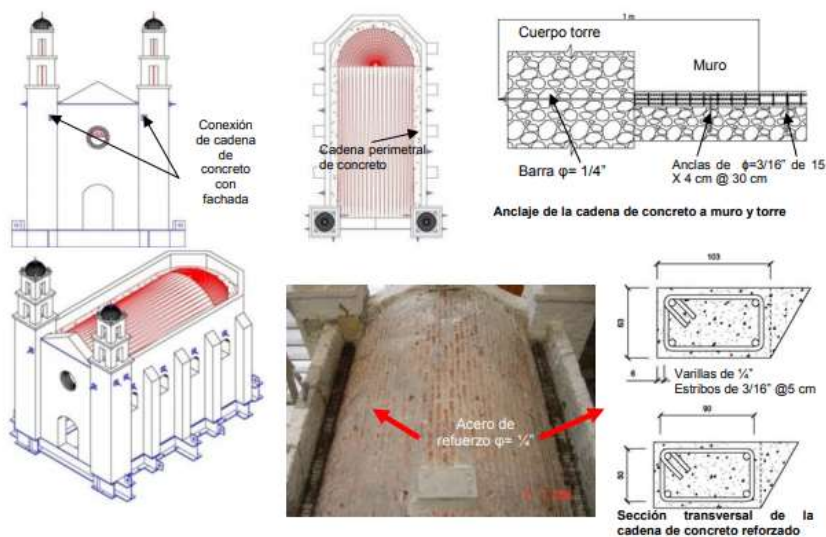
12- Sistema de refuerzo de cadena de concreto reforzado aplicado a un modelo a escala de un templo (Chavez M, 2010).
